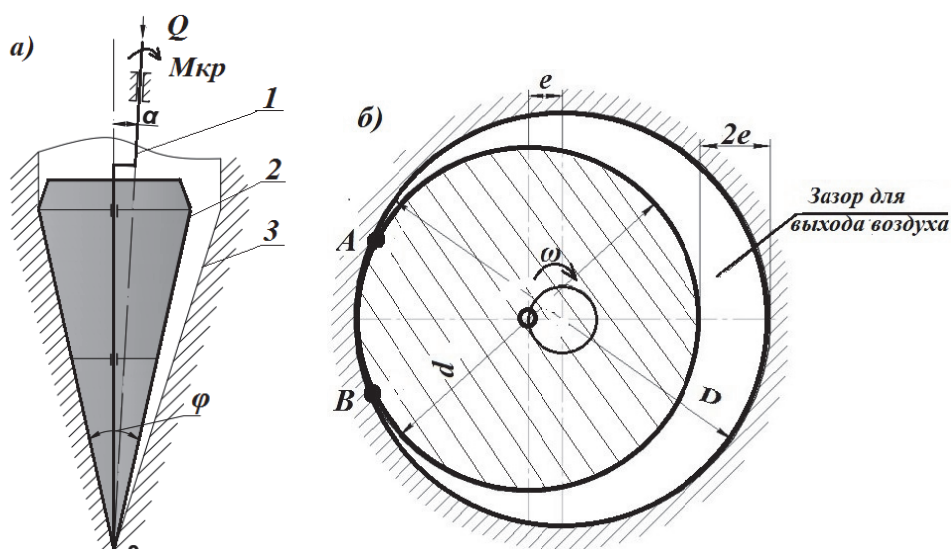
Схема конусной раскатки котлована: а – вид сбоку; б – вид сверху.
